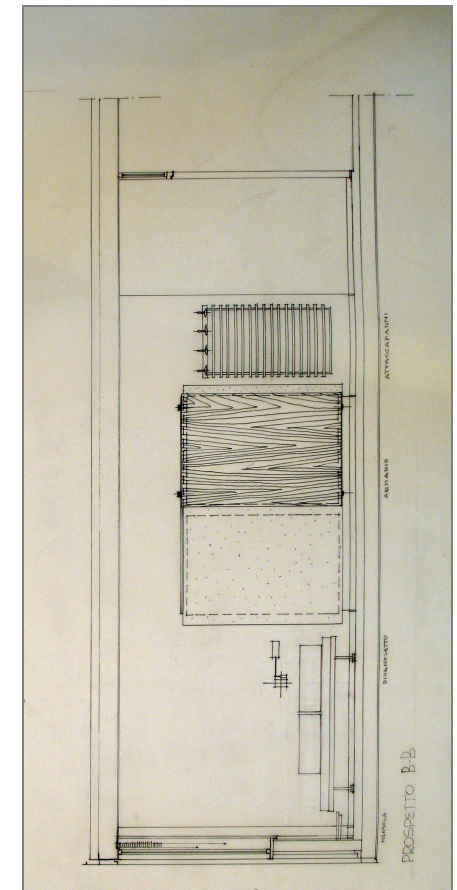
camera tipo, prospetto BB (fonte CSAC – stralcio tav. 33, archivio n. 276-1)
